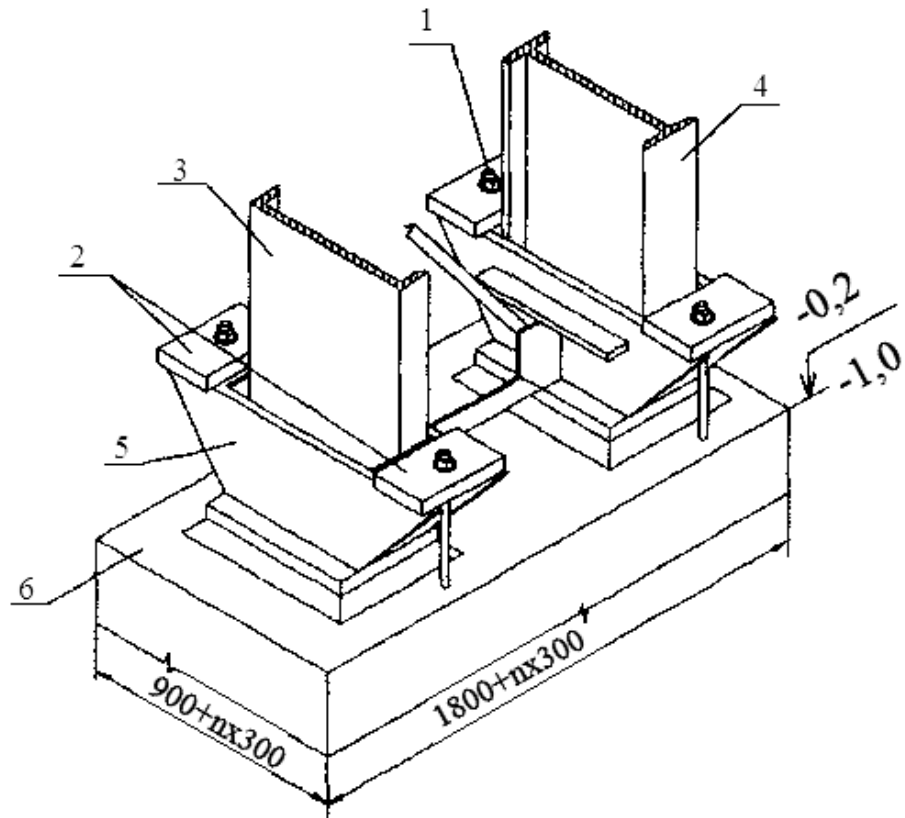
Фундамент стаканного типа для колонн одноэтажных промышленных зданий
